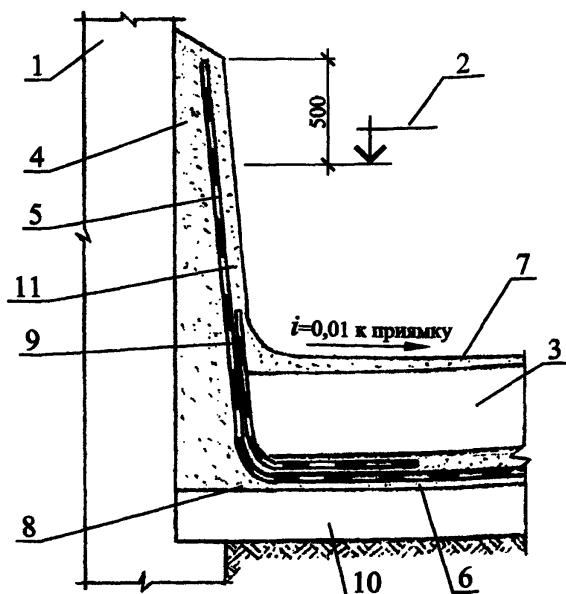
Гидроизоляция реконструируемых подвалов по существующему бетонному полу, при уровне грунтовых вод от 15 до 50 см
